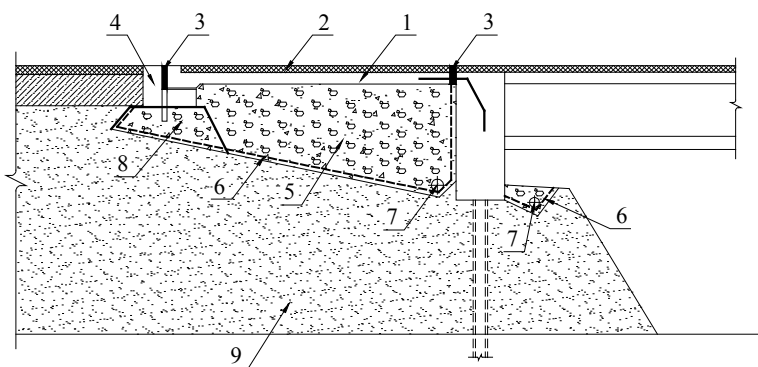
Конструкция сопряжения интегрального устоя путепровода с насыпью подхода: 1 — переходная плита; 2 — асфальтобетонное покрытие; 3 — полимерно-битумная мастика; 4 — железобетонный лежень; 5 — щебень; 6 — дренажный геокомпозит; 7 — дренажная труба; 8 — песчано-гравийная подушка; 9 — песчаный грунт насыпи
